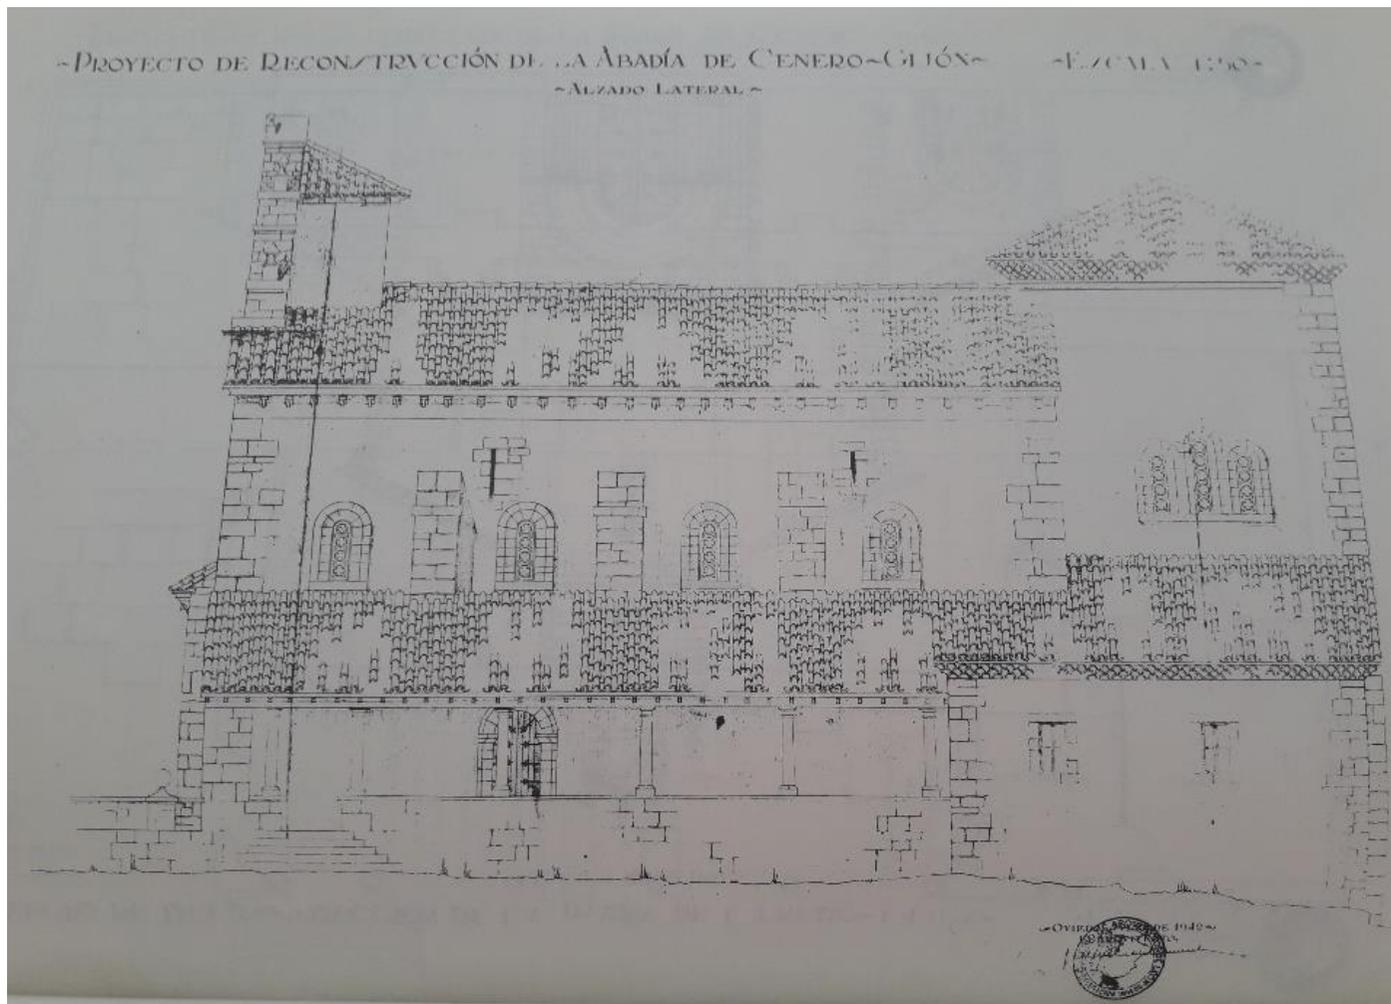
Alzado lateral del proyecto original, sin pórtico que cubra la portada románica
